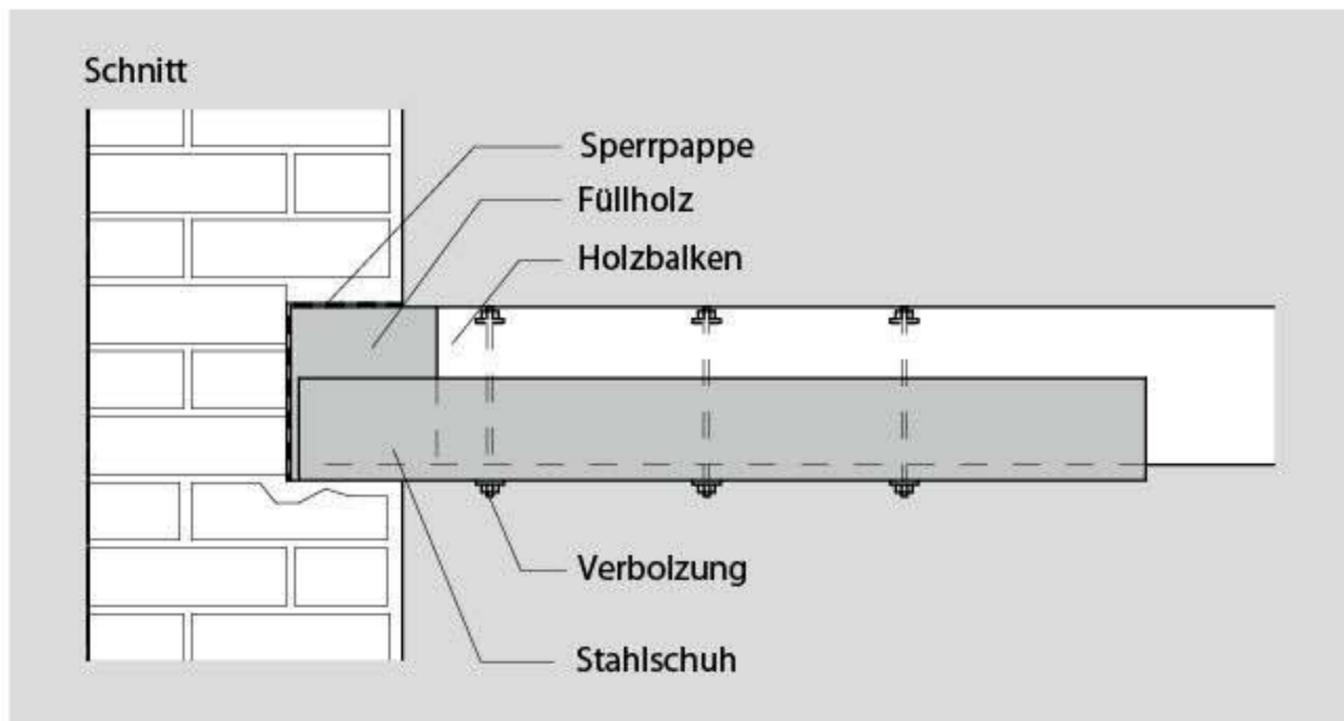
Einbau von Stahlschuhen zur Sanierung von Balkenköpfen
